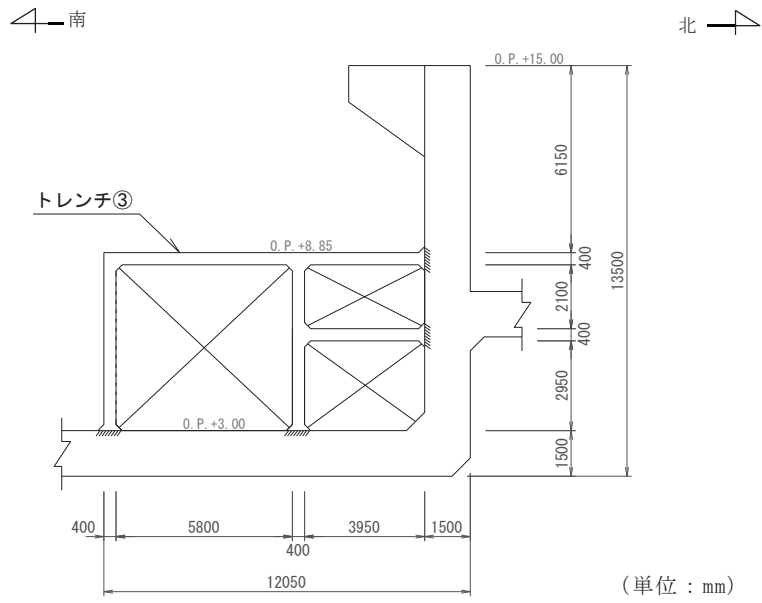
(9) 補機ポンプエリア断面図 (⑨-⑨断面)
